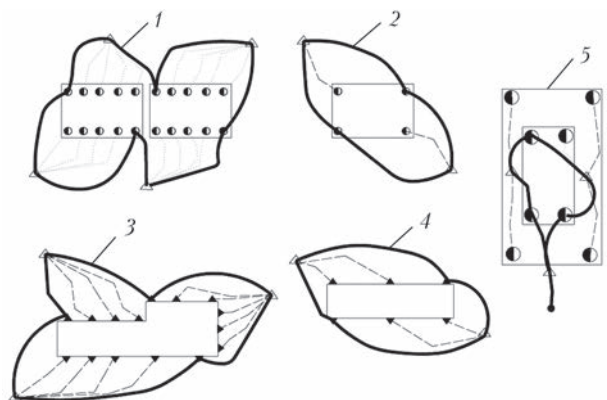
Схема нівелювання окремих агрегатів: 1 – установка охолодження газу; 2 – установка очистки газу; 3 – службово-експлуатаційний і ремонтний блоки; 4 – склад запасних частин; 5 – турбоагрегати
